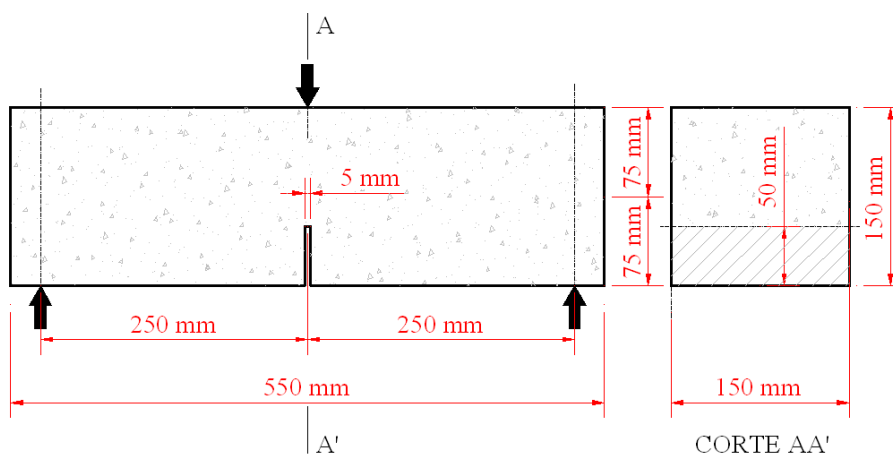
Dimensões do corpo-de-prova prismático com entalhe no centro do vão.
